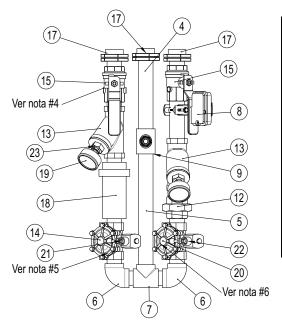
Detalle de autolimpieza de 1" con colector de gabinete utilitario de montaje en pared CORE
